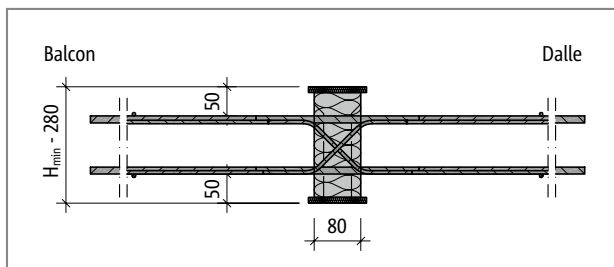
Schöck Isokorb® T Type D pour CV50 : Coupe du produit
